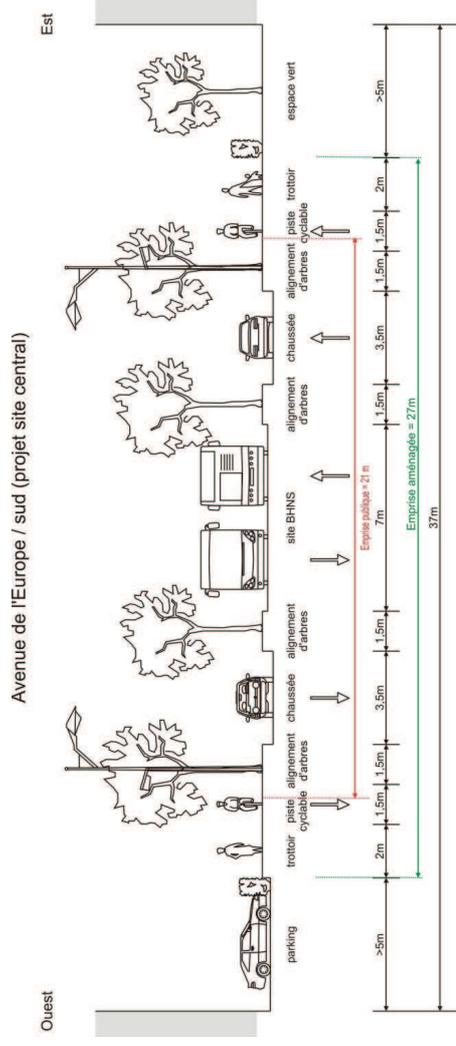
Situation projetée (coupe 28) avenue de l'Europe / section "Sud"
